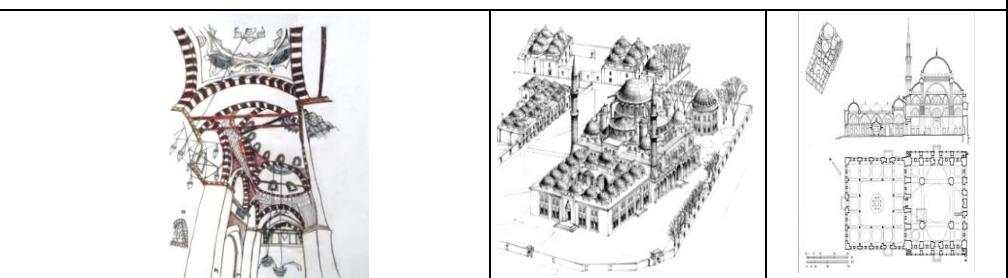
مسقّط أفقي ومنظور لجامع مهرماه في اسكيار باسطنبول يوضح السقيفه المزدوجة التي تقدمه. (عن: كوران بتصرف).
